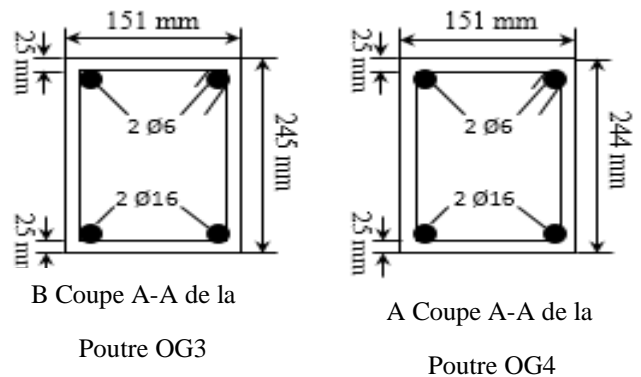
La géométrie et ferrailage des poutres OG [29]
